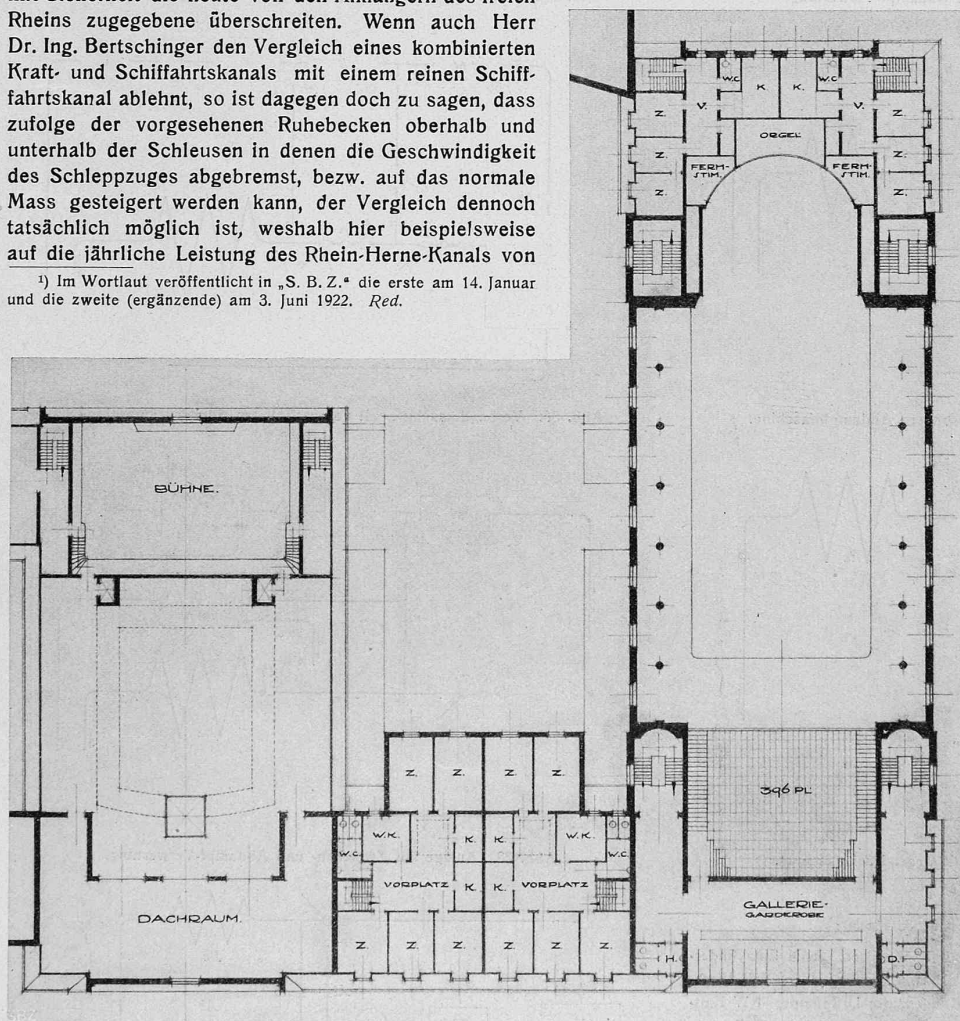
Grundriss vom Dachgeschoss. — Masstab 1 : 600.
